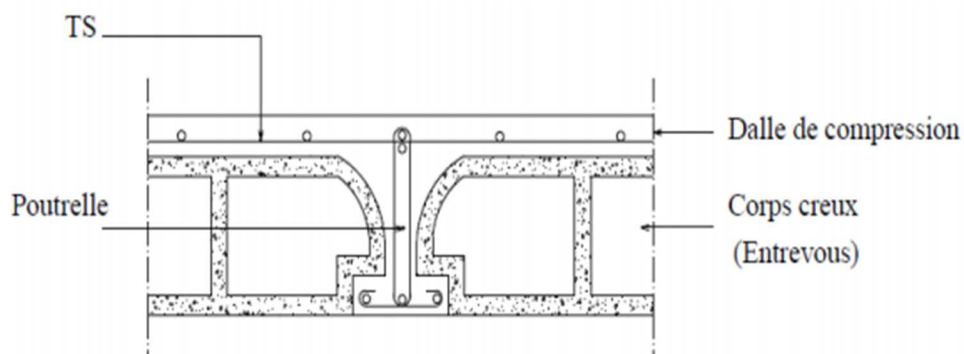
Coupe Transversale D'une Plancher A Corps Creux
